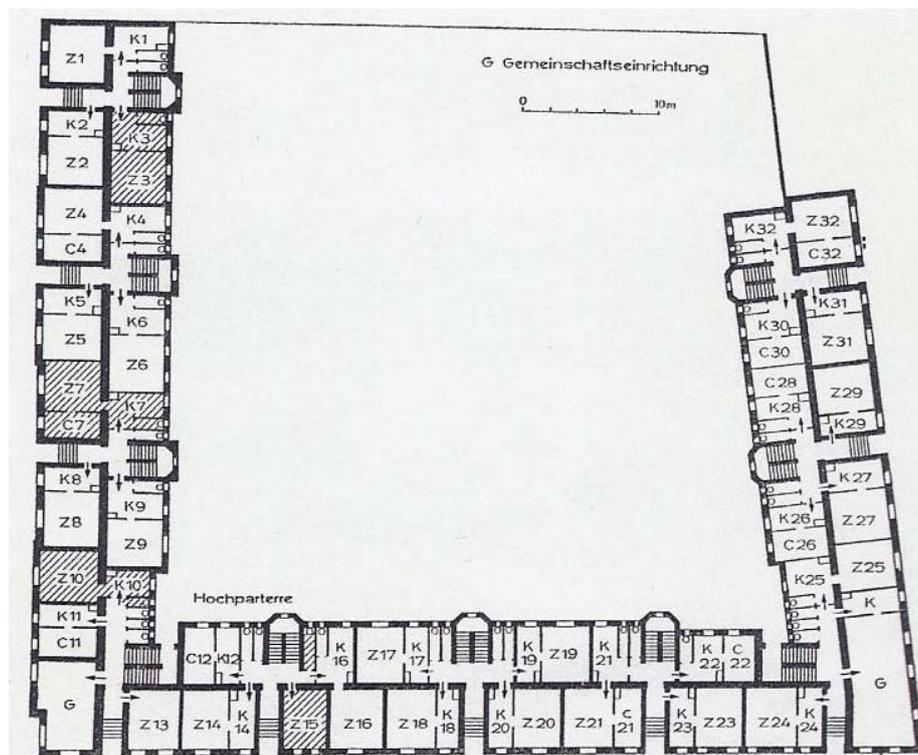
Jubiläumshäuser - Grundriss Hochparterre
